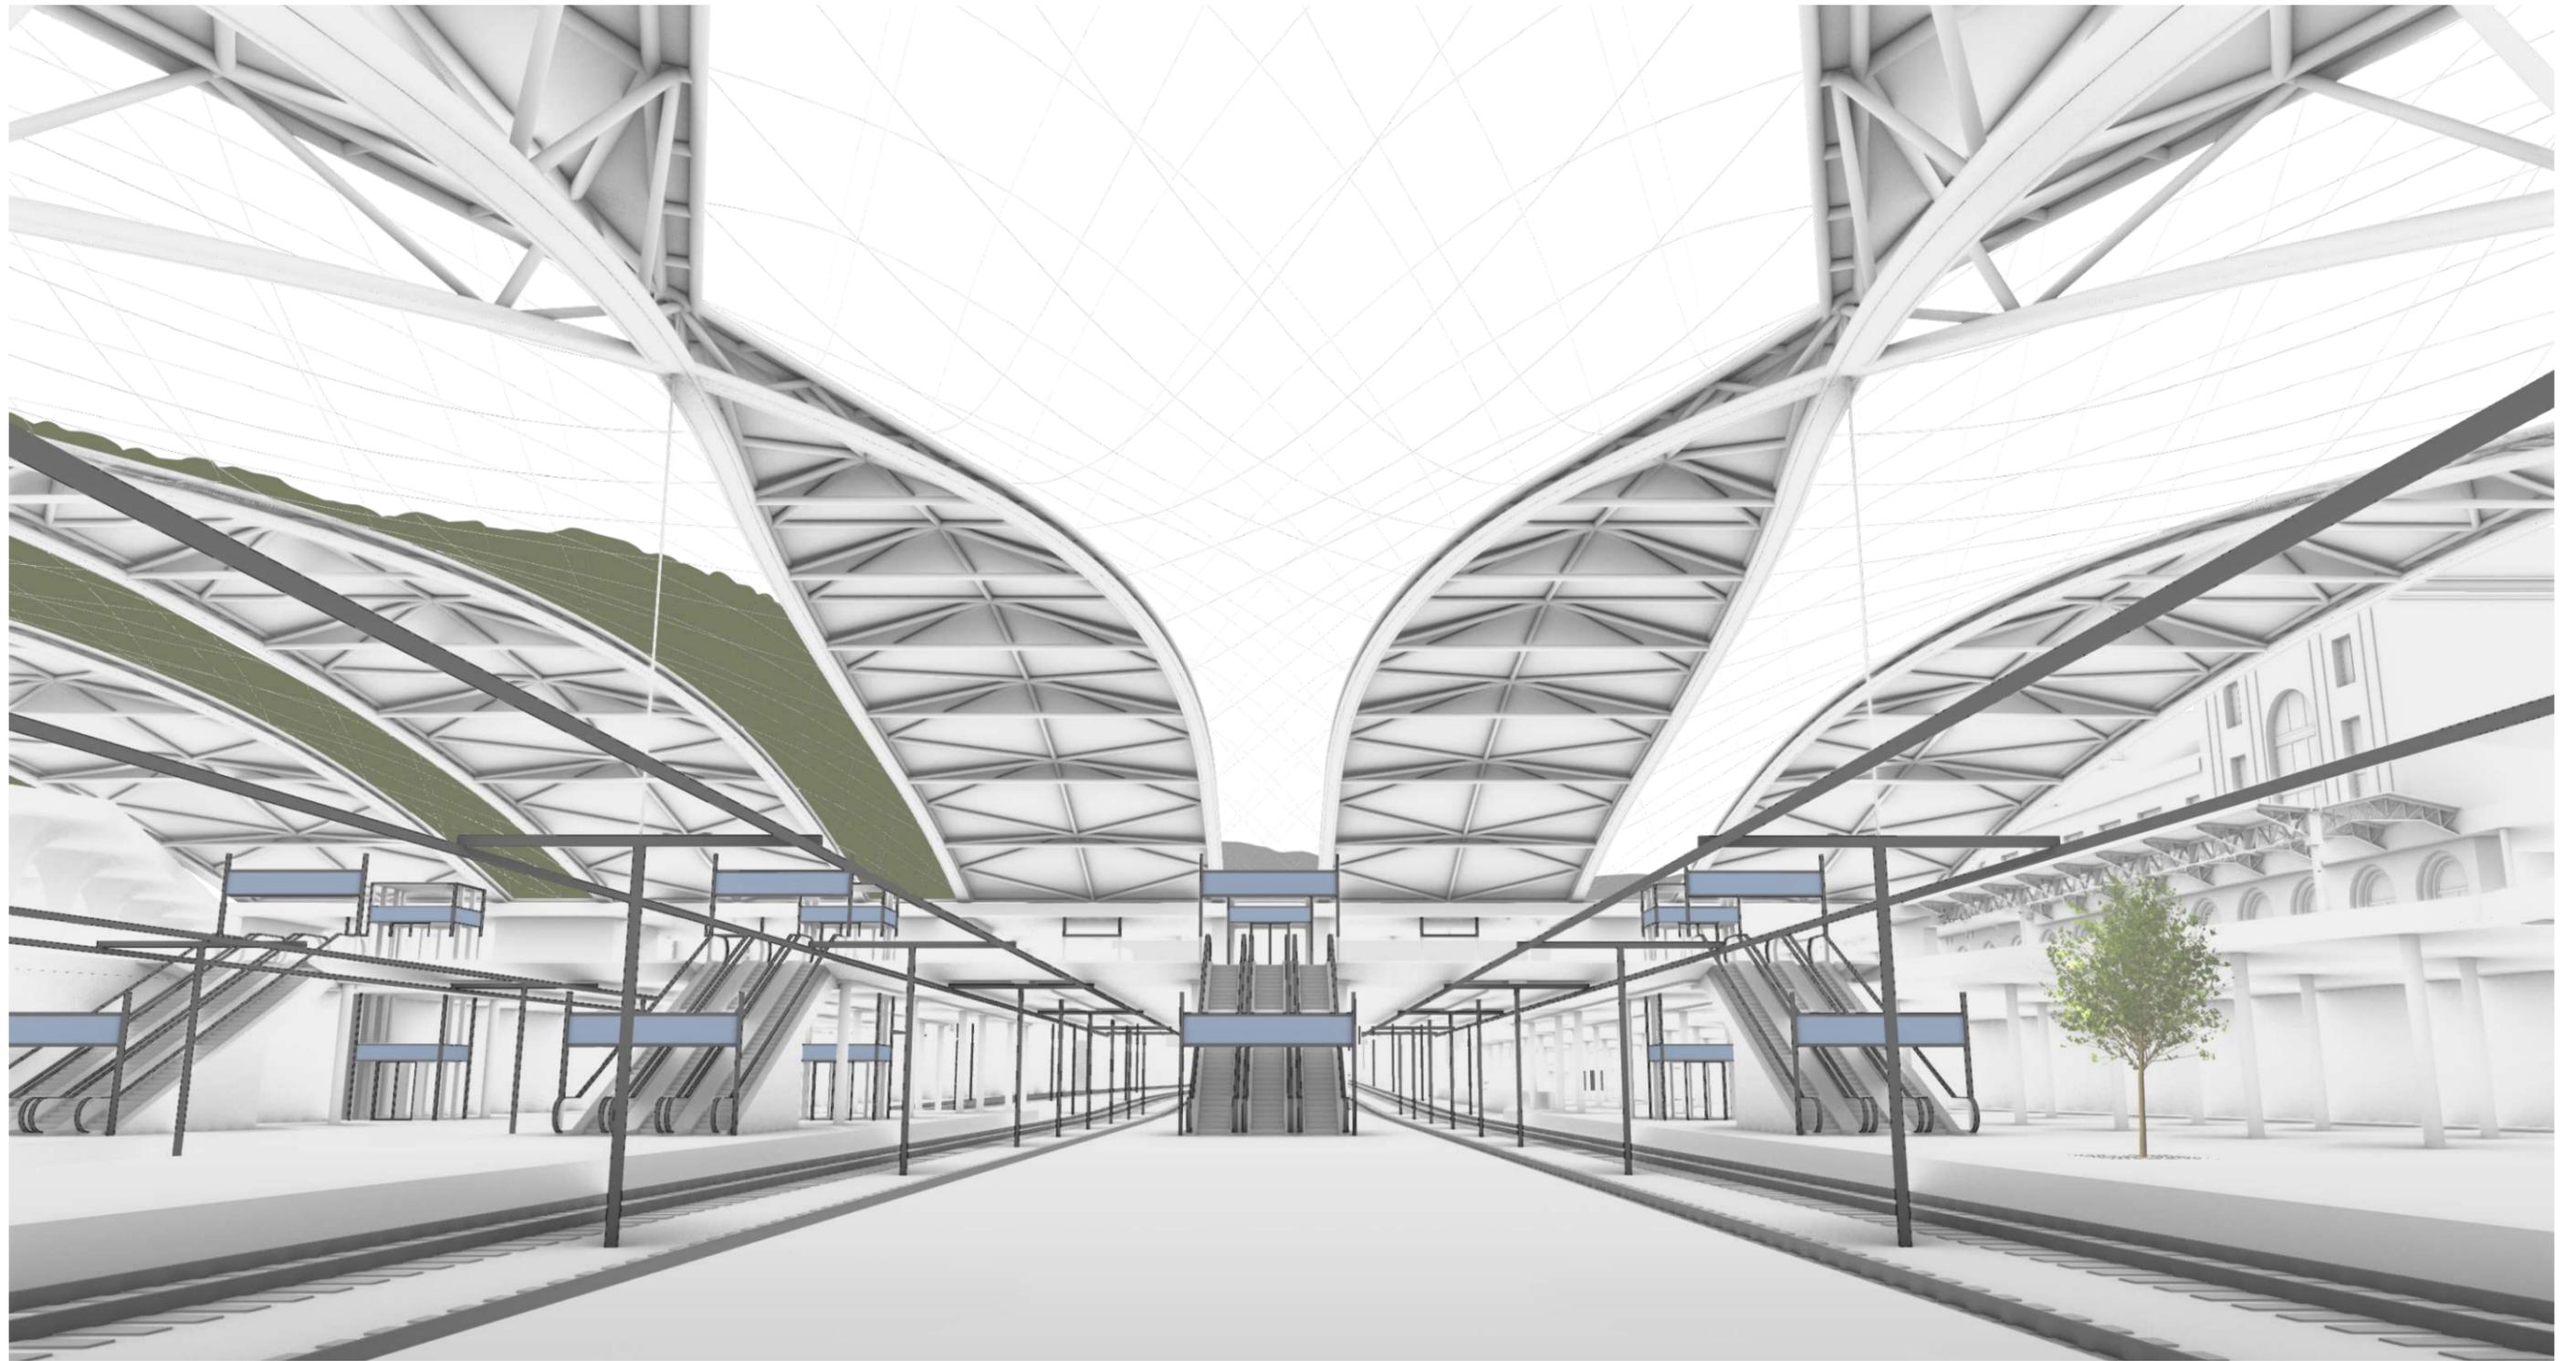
Schaubild: Die Bahnhofshalle mit Brücke und Bestandsgebäude
